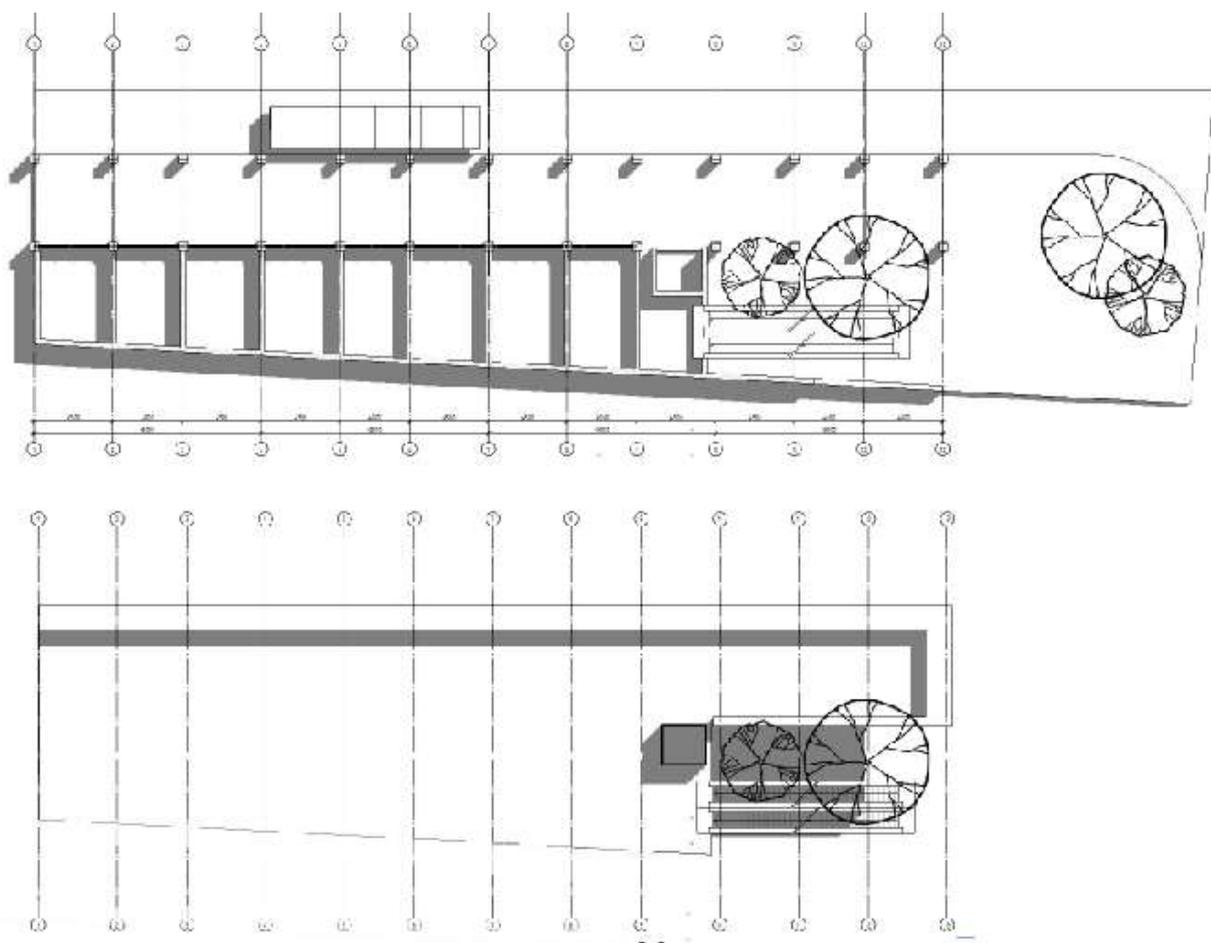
Планировка остановочной станции 7 (Чертеж авторов)
